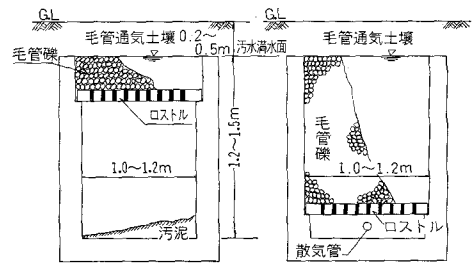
土壌式沈殿池標準断面図および土壌式循環接触ばき槽標準断面図
